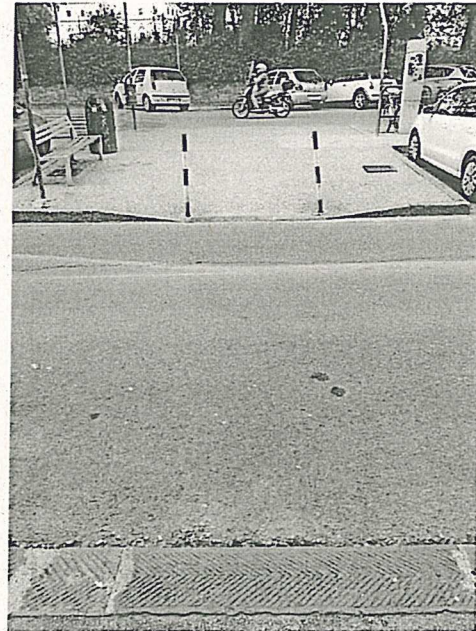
Attraversamenti su L.no Santa Rosa a servizio dell'ASL
